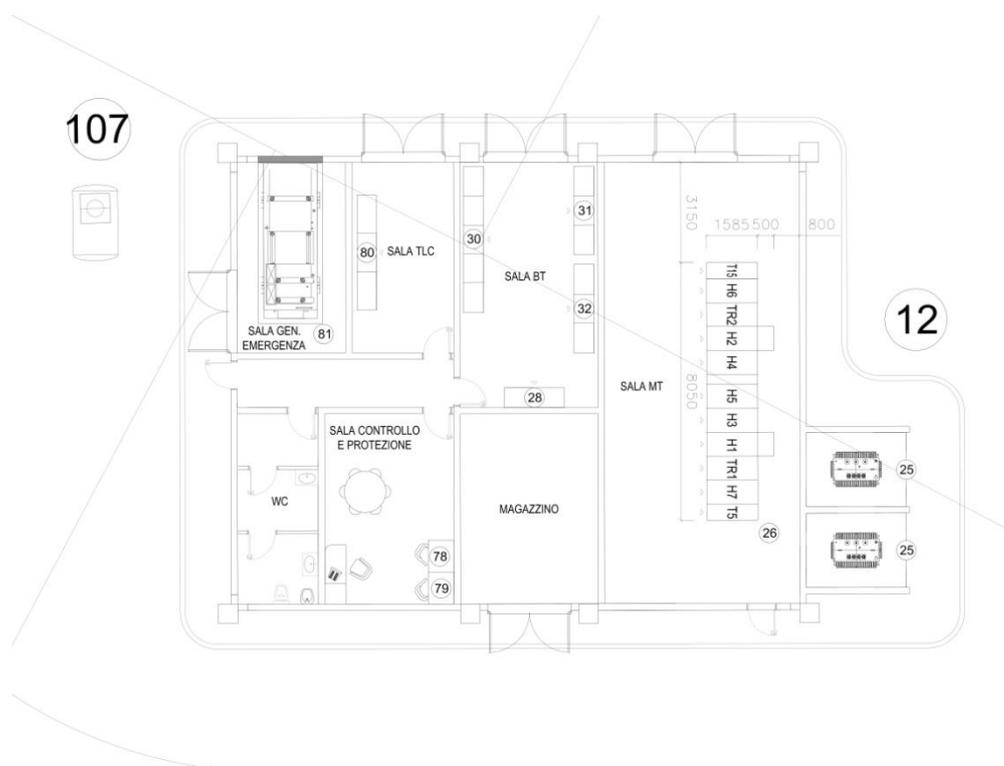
Planimetria Edificio Elettrico MT/BT e Servizi Ausiliari
